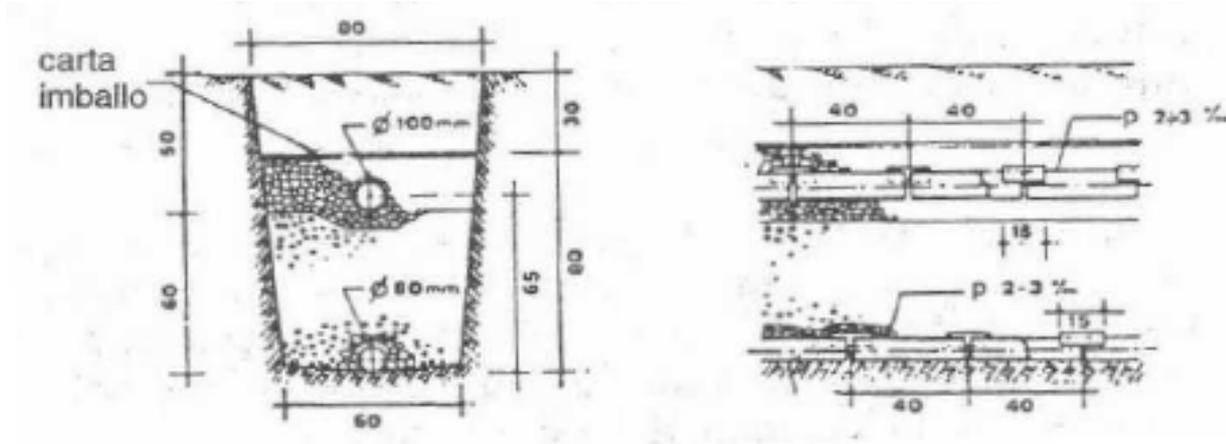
pianta e sezione longitudinale esemplificative di subirrigazione drenata (dal "Manuale dell'Architetto")
